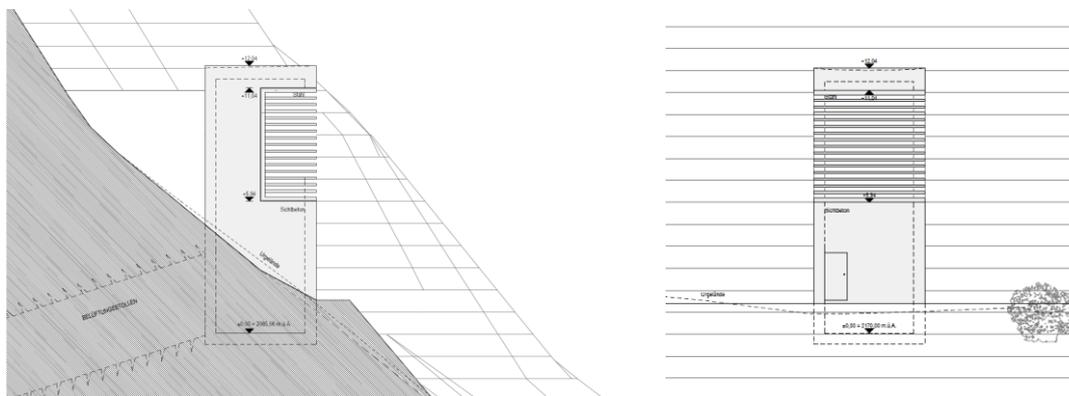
Ansicht Belüftungsbauwerk Wasserschloss Krespa (siehe Beilage 4.8)
